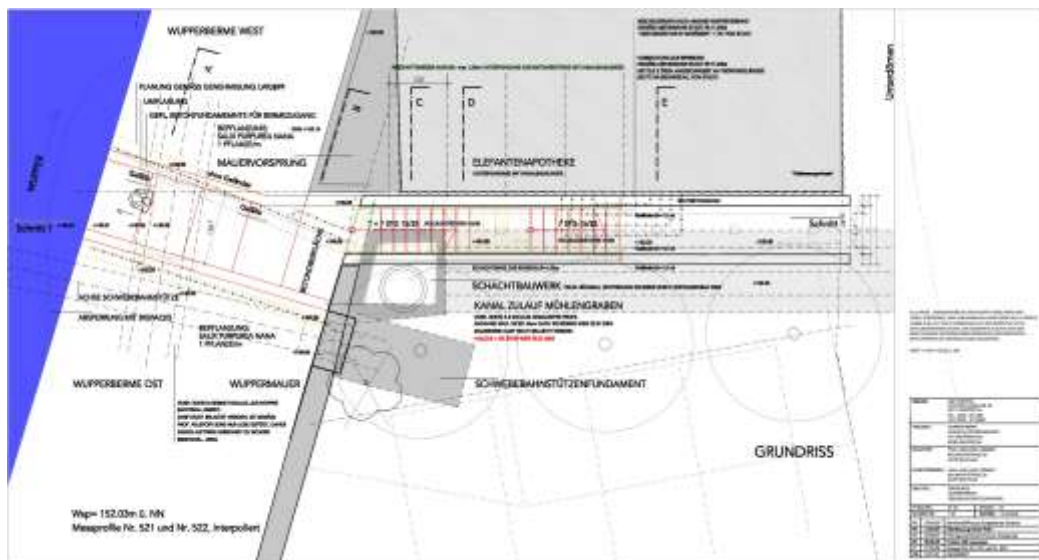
Lageplan Maßnahme Wupperzugang durch Treppenanlage an der Adlerbrücke
